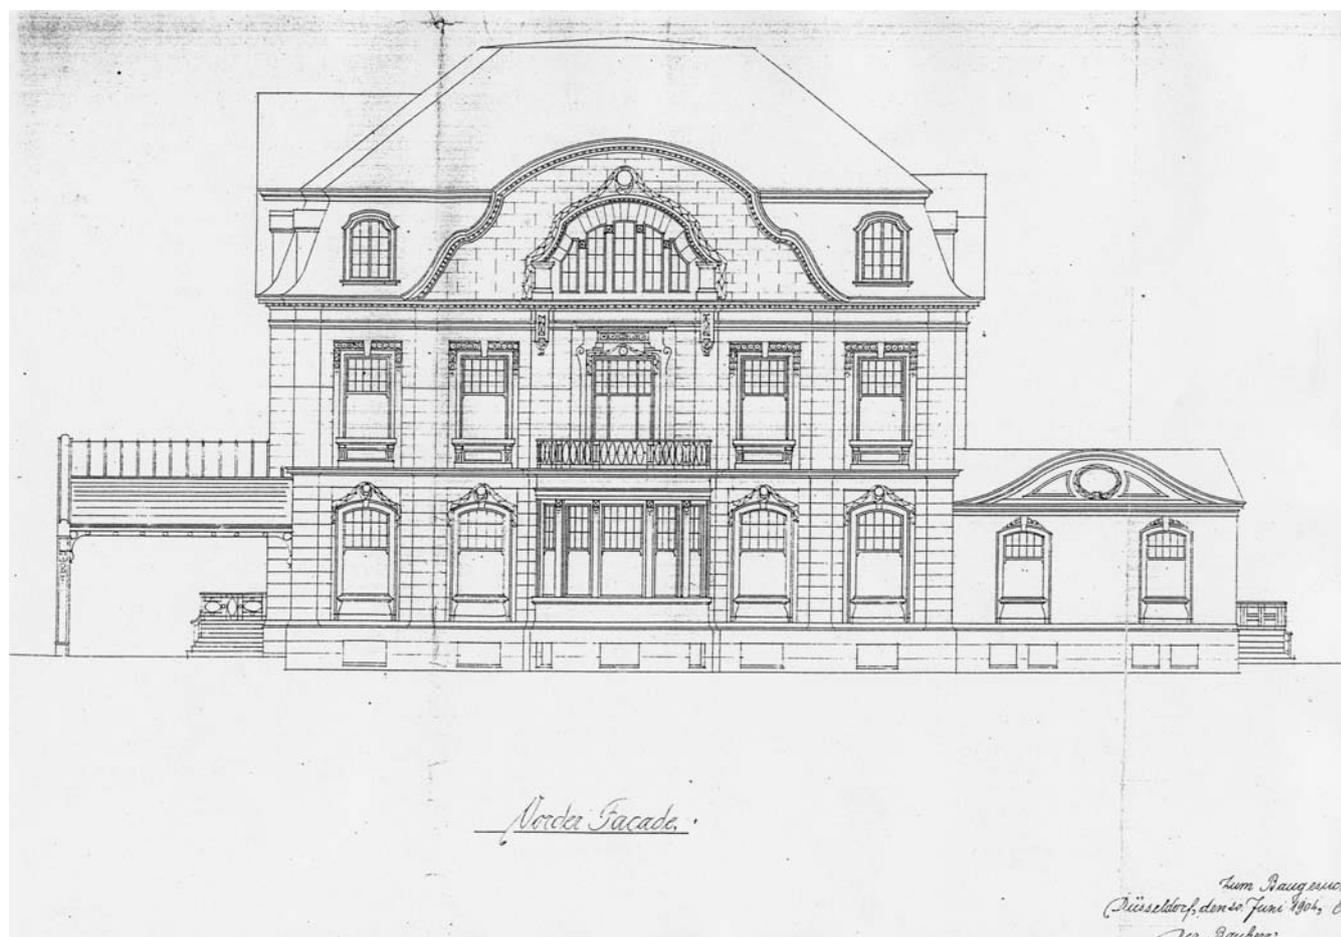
H. Plange, Wohnhaus Röder, Hauptfassade zur Straße, Aufriss 1904
